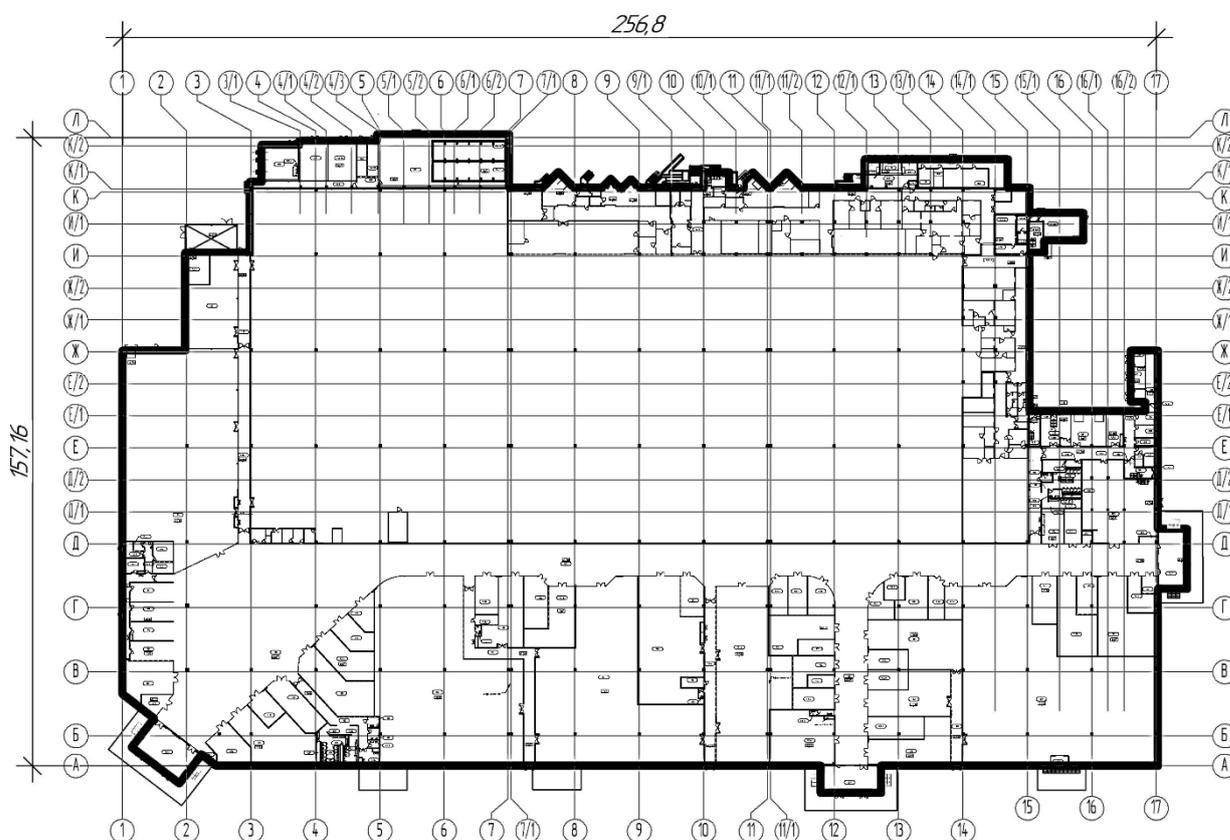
План расположения помещений в здании ТРК на уровне первого этажа
